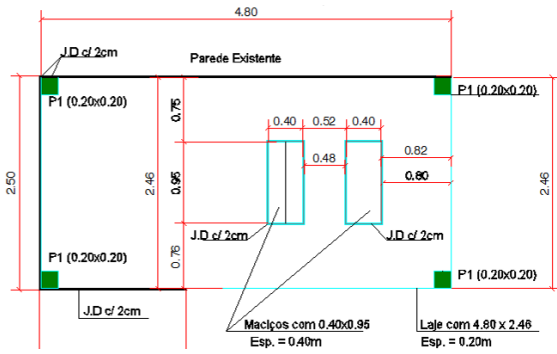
Planta estrutural da base do edifício do gerador [AVicêncio C, 2017]
